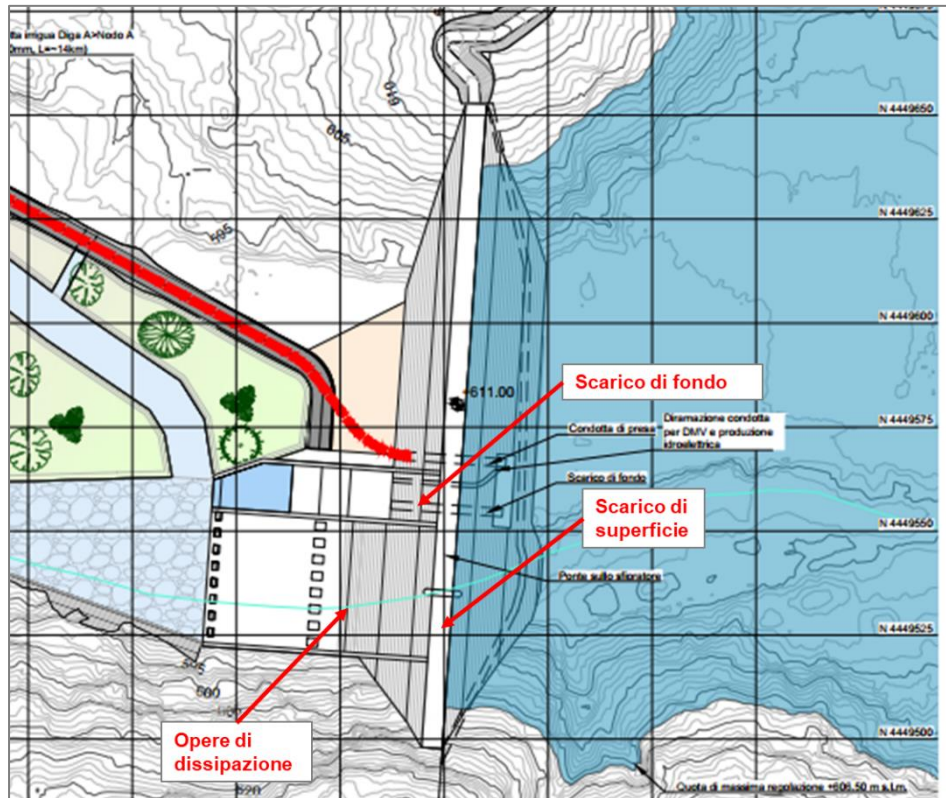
Alternativa 2: planimetria di inquadramento della Diga A1
